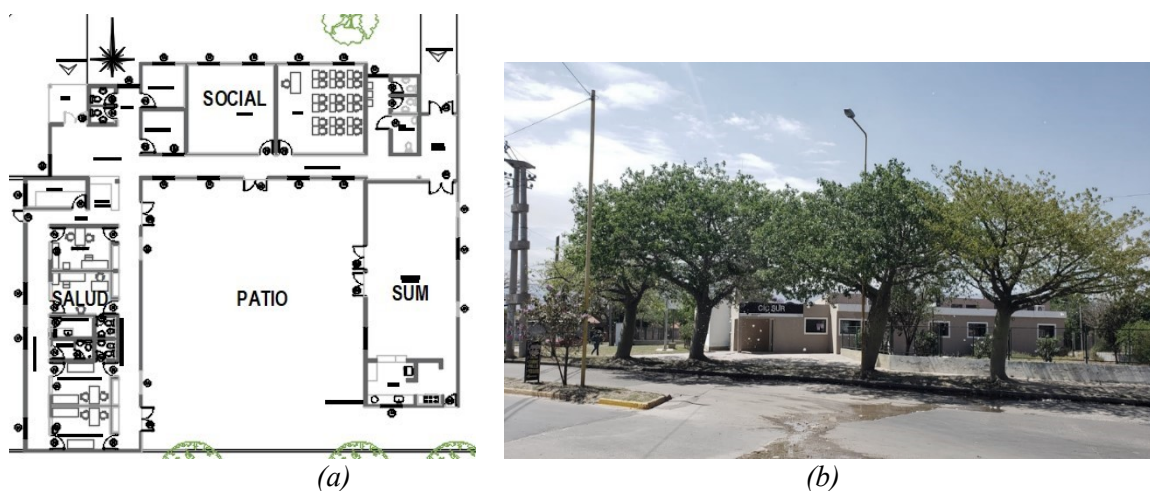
CIC Sur, (a) Planta General, (b) Vista oeste, ingreso y sector Salud
